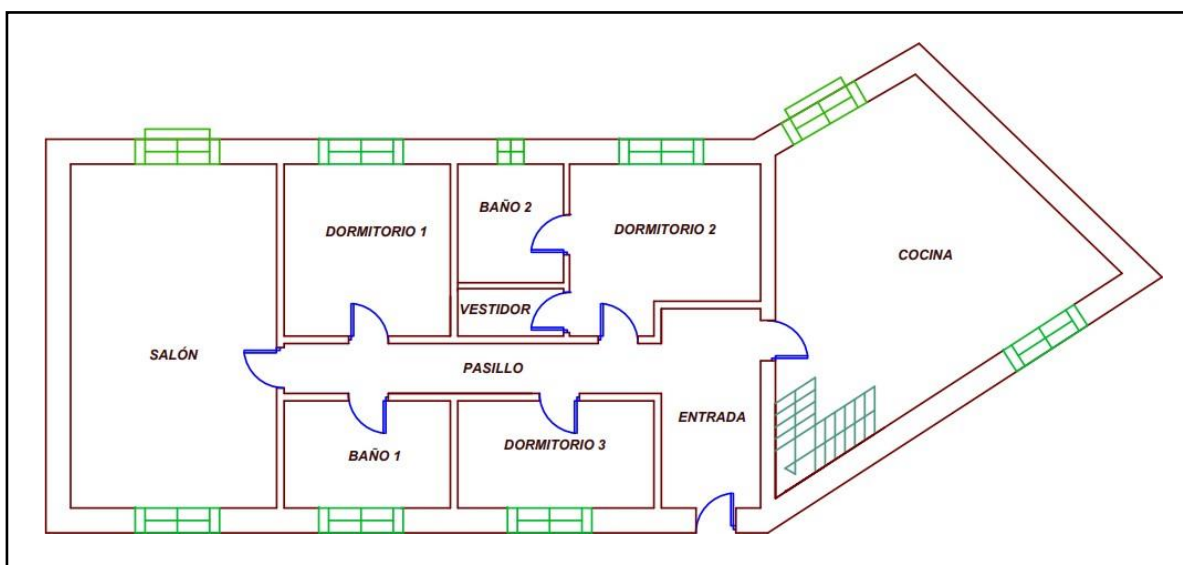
Plano de la planta acondicionada de la vivienda (Fuente propia)
